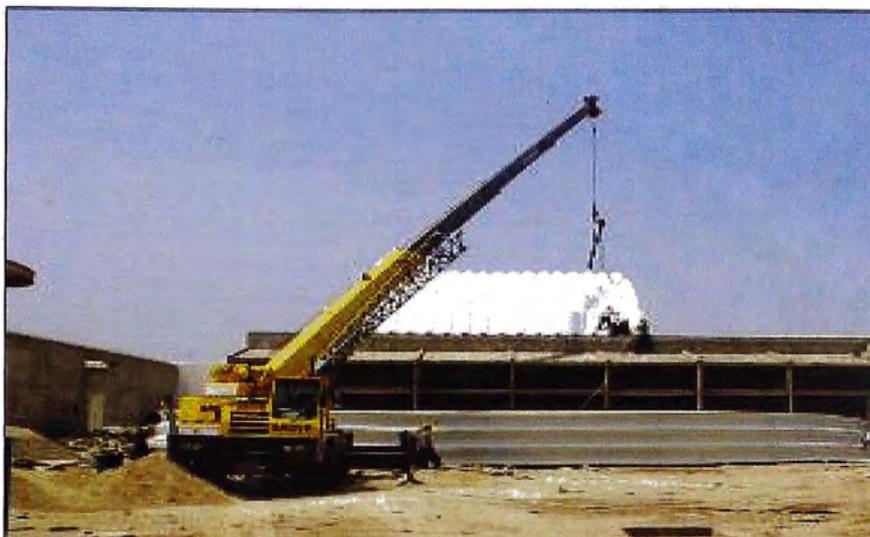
Vista de la recepción y colocación de la terceta en el techo.
